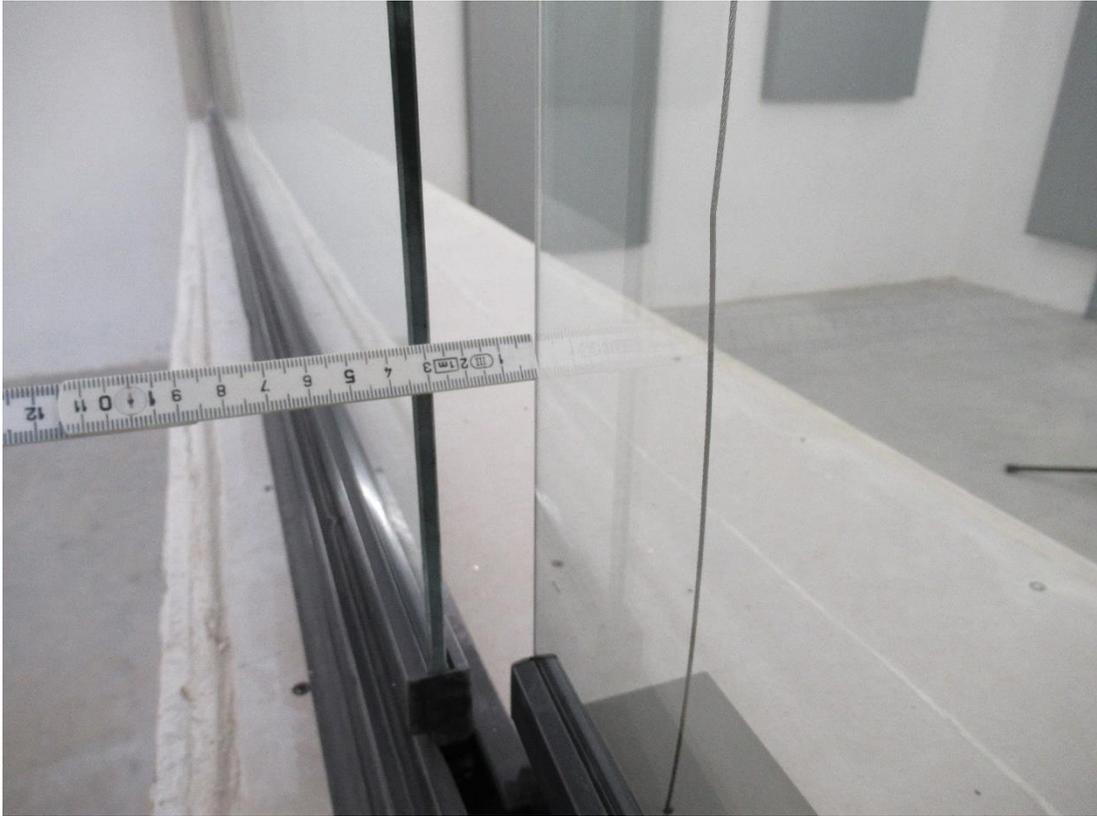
vue de salle d'émission, stores (Mesurage 3)
